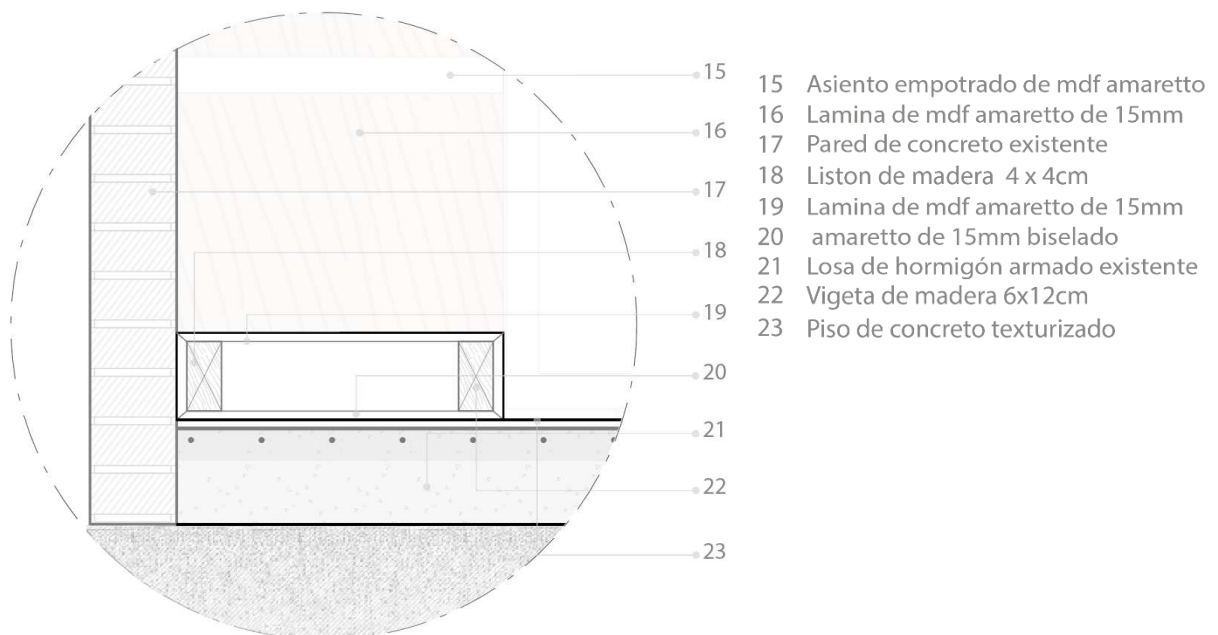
Detalle constructivo D2-2 y especificaciones técnicas del subsuelo de la unidad académica de ingeniería industria y construcción.
